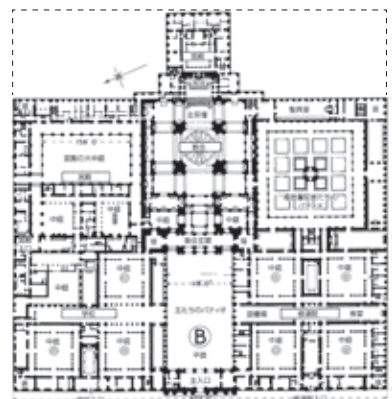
サン・ロレンツォ・エル・エスコリアル 平面図 1562-1582年
